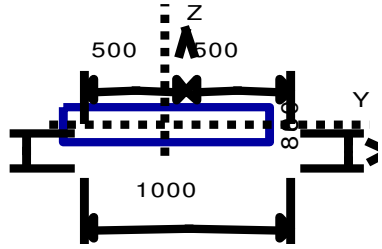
Конструктивное решение плиты перекрытия
